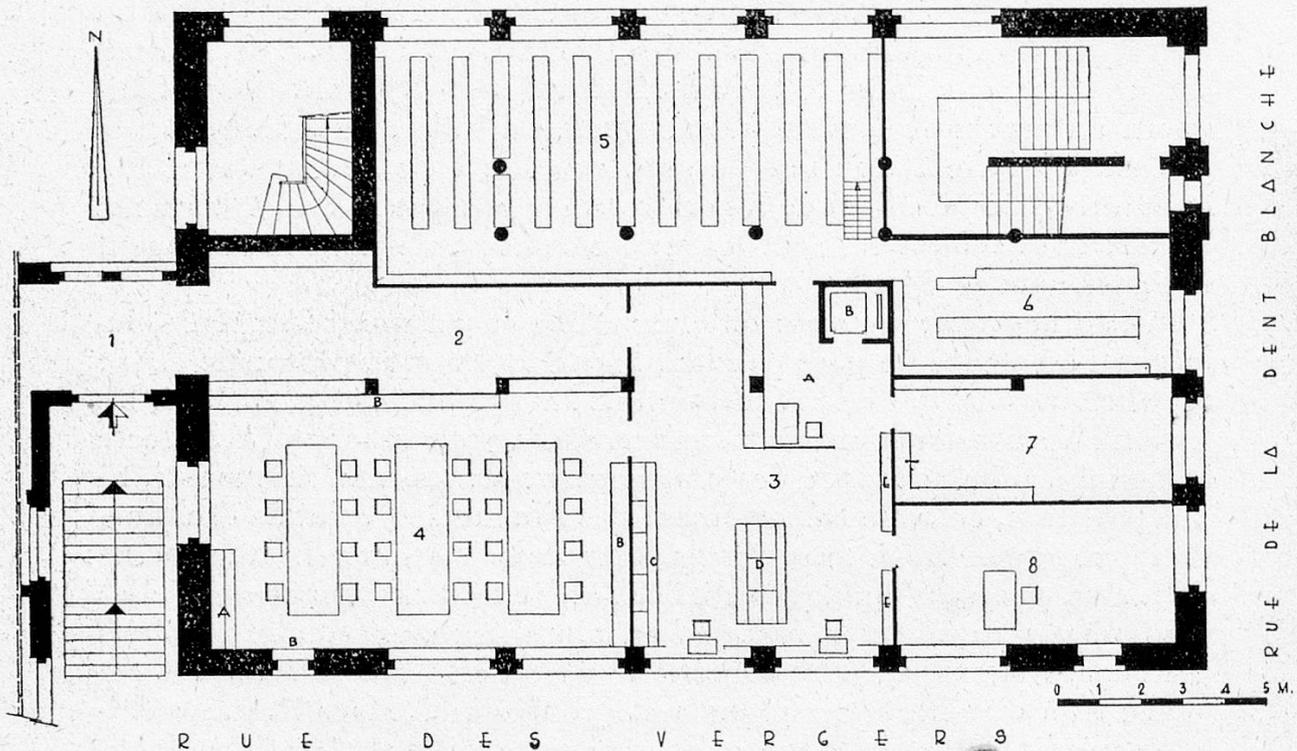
La Bibliothèque. Plan du rez-de-chaussée.
